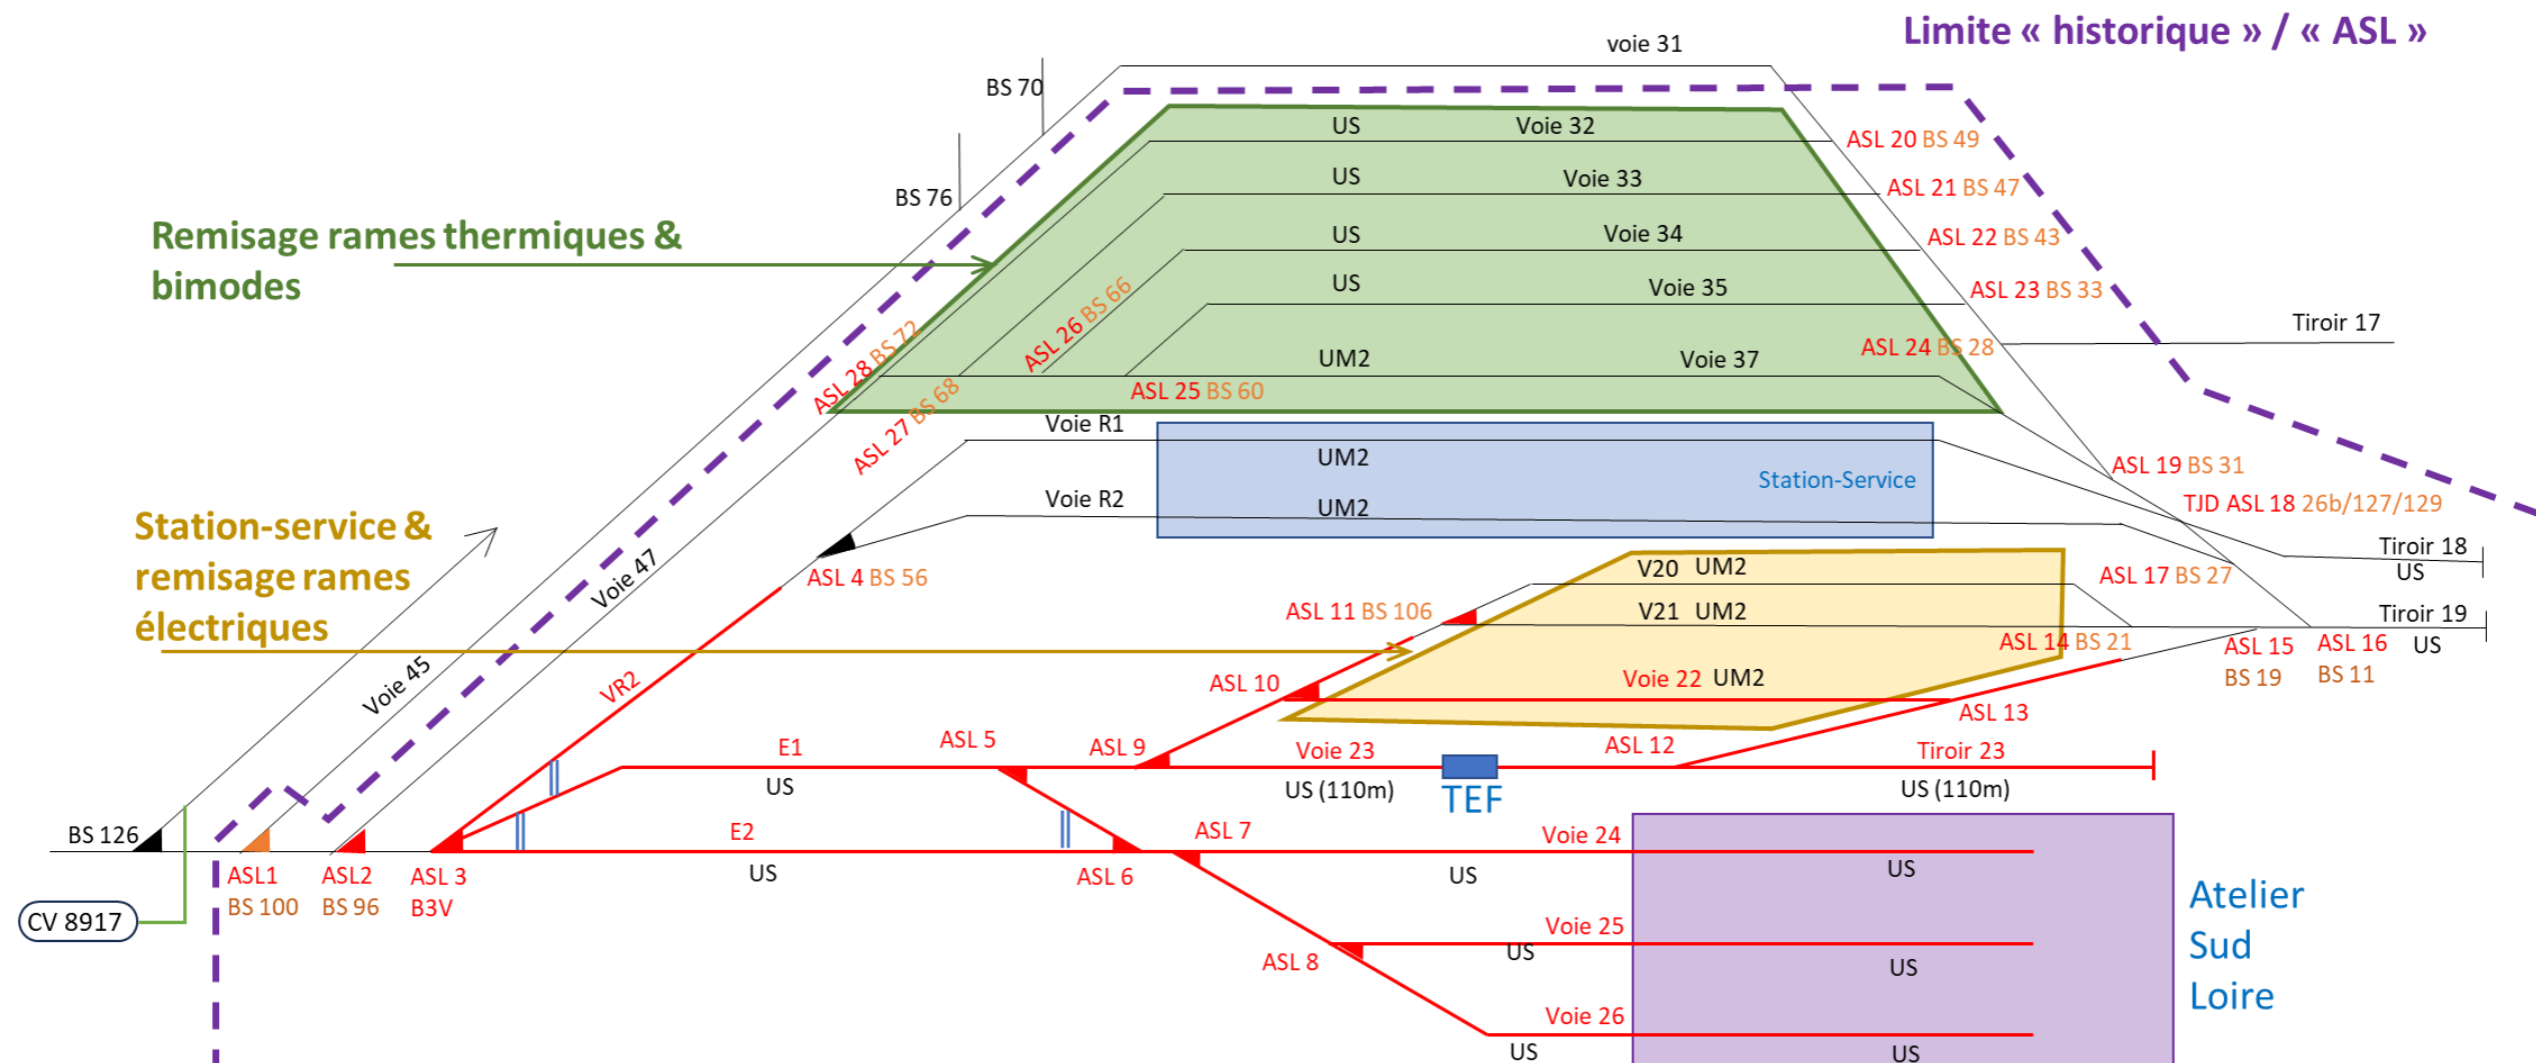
SCHEMA DES INSTALLATIONS FERROVIAIRES PROJETEES DU PERIMETRE TCSL (OU ASL) (SOURCE : DOSSIER PRO)
